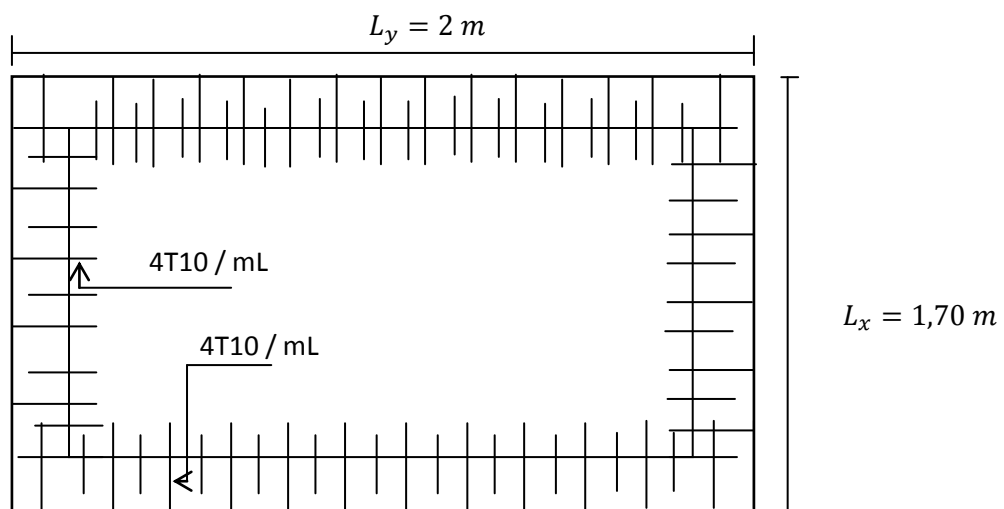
Ferrailage inférieur de la dalle de l'ascenseur.
